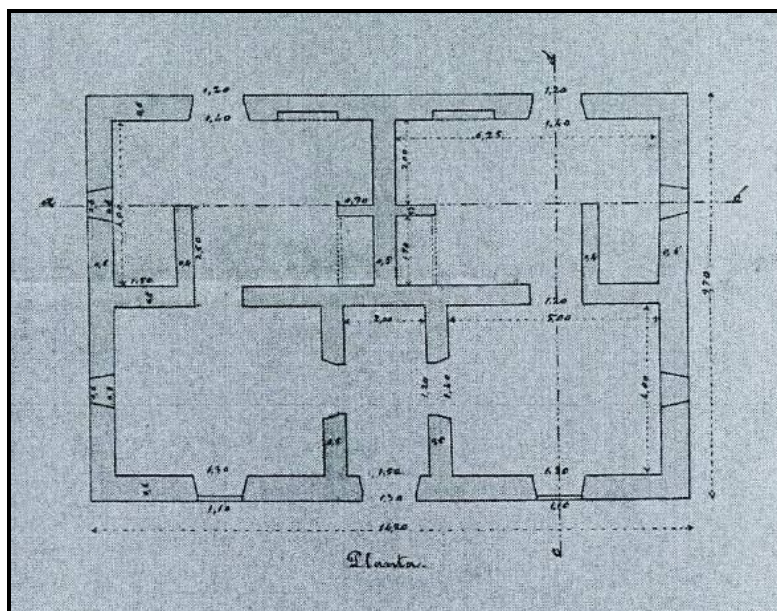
Planta das casas de cantoneiros para a estrada de Faro a Castro Verde
